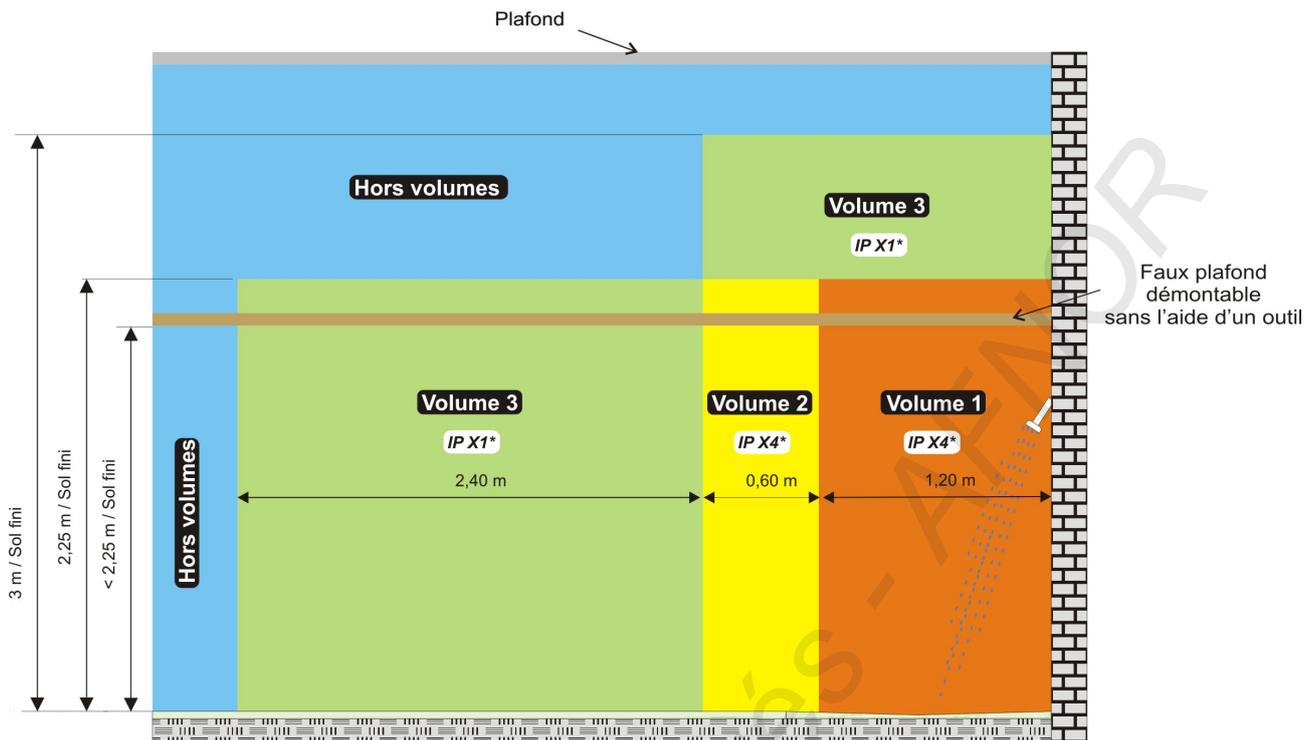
T – Faux plafond démontable sans l'aide d'un outil situé à moins de 2,25 m du fond du receveur ou de la baignoire
